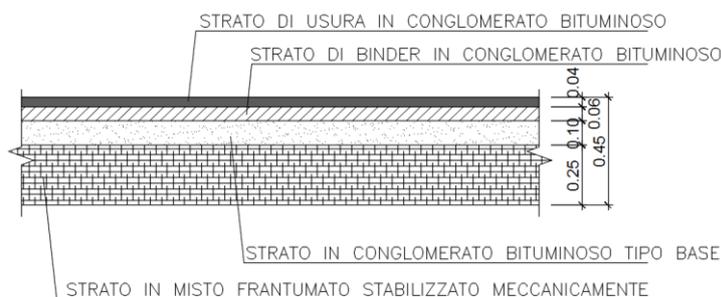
Pacchetto pavimentazione Strada C1 Extraurbana Secondaria
